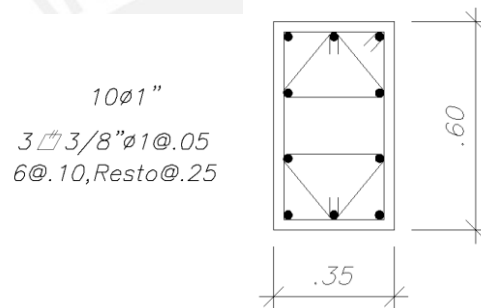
Refuerzo de columna P1 en segundo sótano
